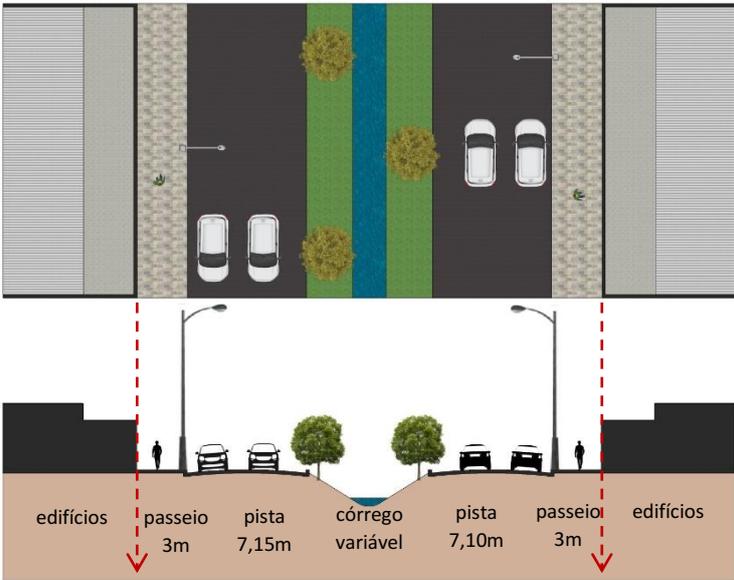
Planta e perfil viário AA da Av. Fátima Porto. Fonte: Desenho do autor, 2020.
